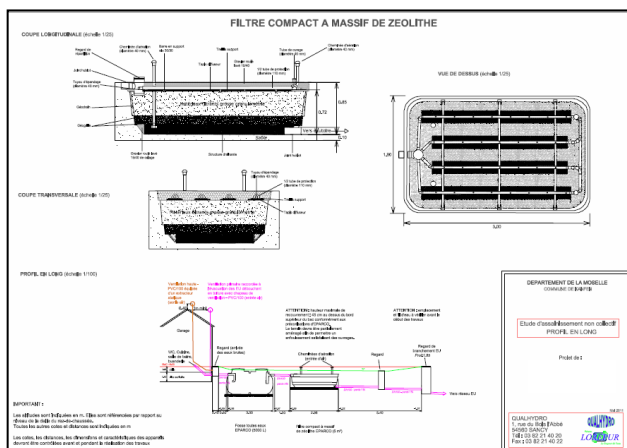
plan en coupe d'un projet d'assainissement non collectif
